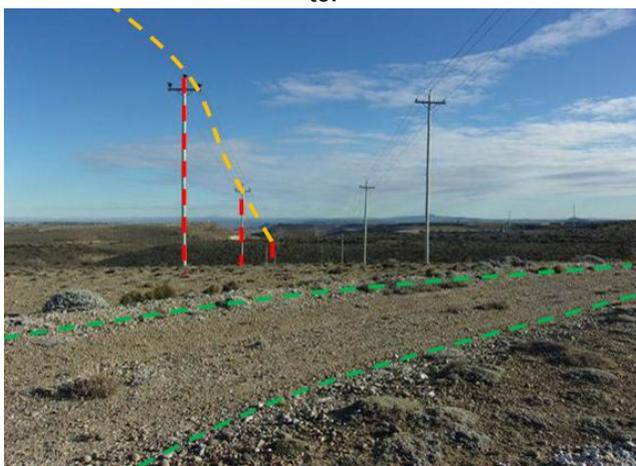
Fotografía III.C-101. Línea eléctrica (naranja) atravesando un drenaje. Foto en dirección Norte.
